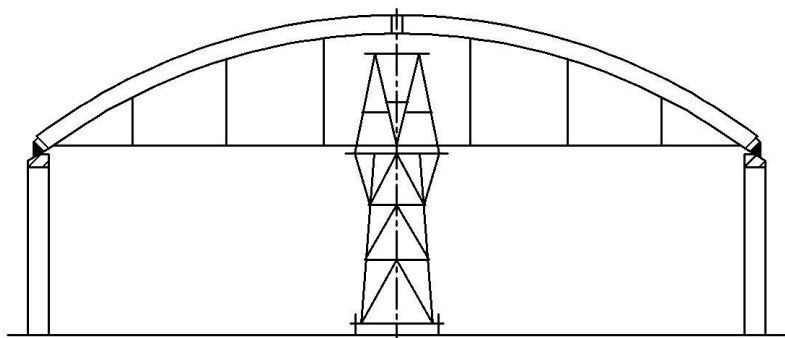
Схема монтажа свода при помощи передвижной решетчатой башни
